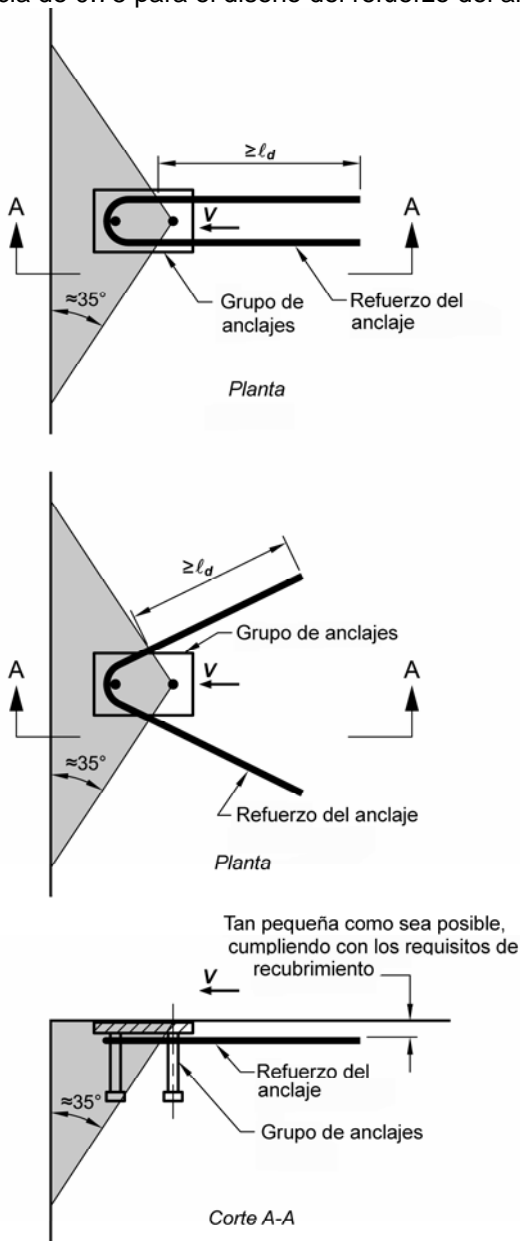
(a) — Refuerzo de anclaje de horquilla para
